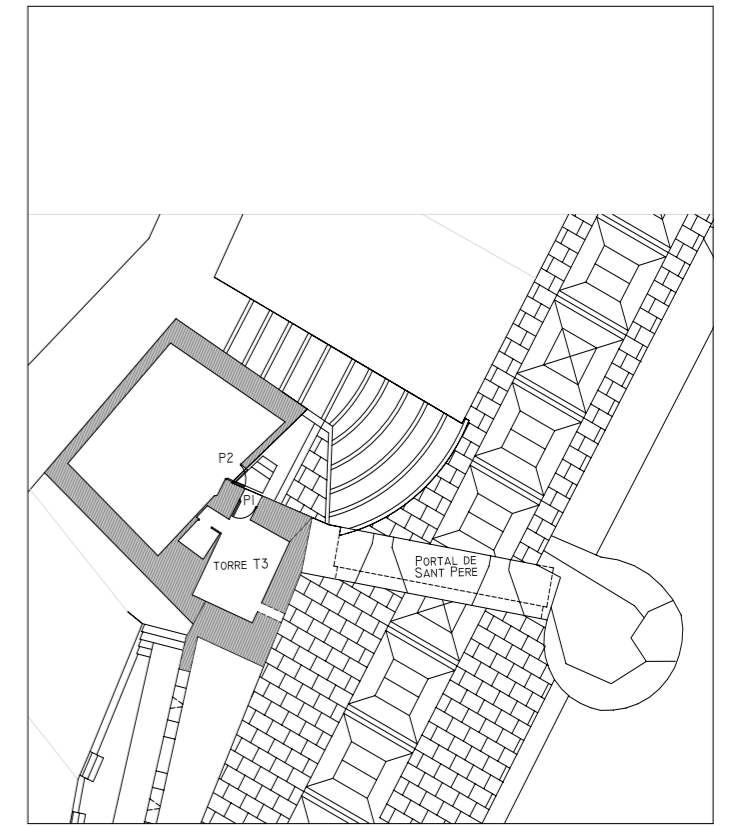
Planta del Proyecto de intervención sobre la batería de Santa Ana y la muralla de la Fuente de Peñíscola. Se representa el interior de la torre T3 del cuerpo de guardia, la puerta de acceso original P1, y su conexión con la vivienda particular. (MJB 2000).
